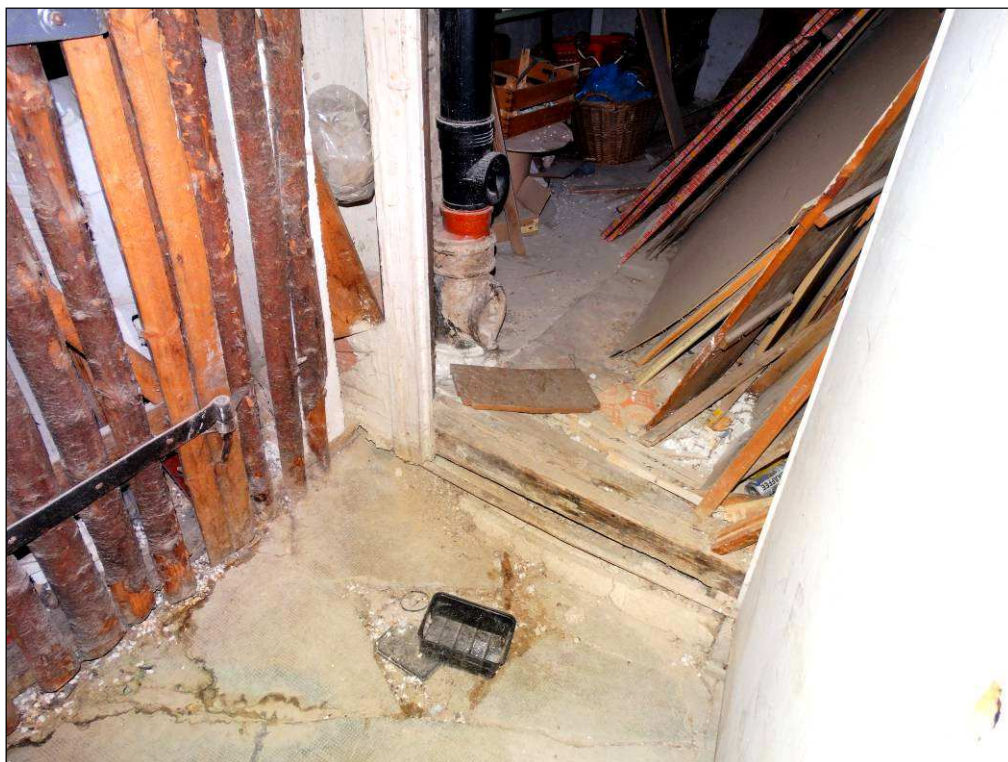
Místo s největším prosednutím podlahy u sklepního boxu k bytu č. 14.
